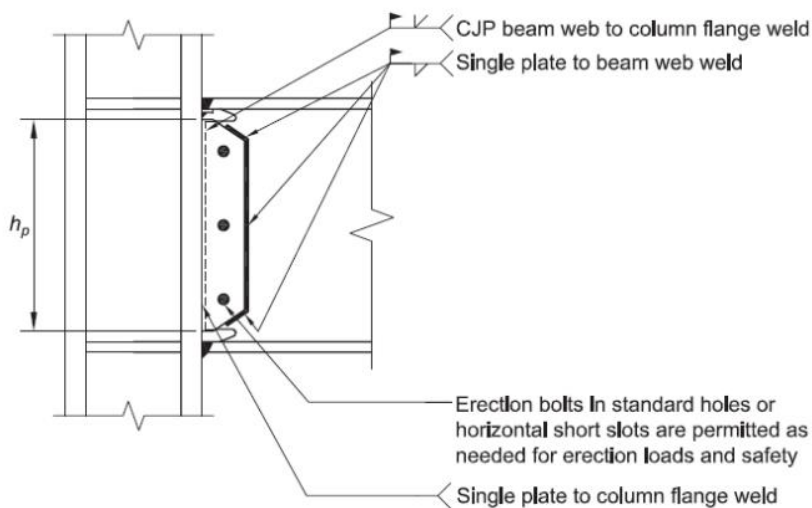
Welded Unreinforced Flange-Welded Web (WUF-W) Moment Connection – Imagen tomada del ANSI/AISC 358-16
